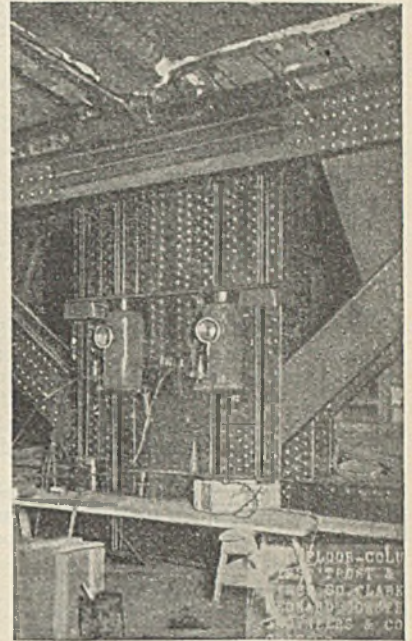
Schwere Stahlfachwerkträger zum Abfangen der von 14 Geschossen auf die Wandstützen zu übertragenden Lasten. (Bemerkenswert die Keile und hydraulischen Winden zur Sicherung der alten Höhenlage bis zum Einbau der neuen Fundamente und Stützen.)
